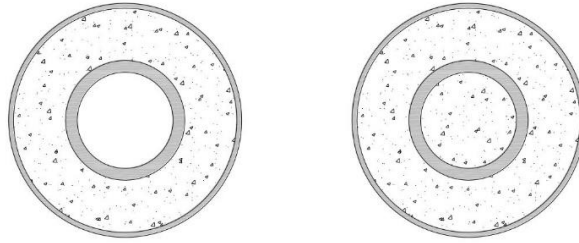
A la izquierda, perfil interior sin rellenar, a la derecha, perfil interior relleno de hormigón.
